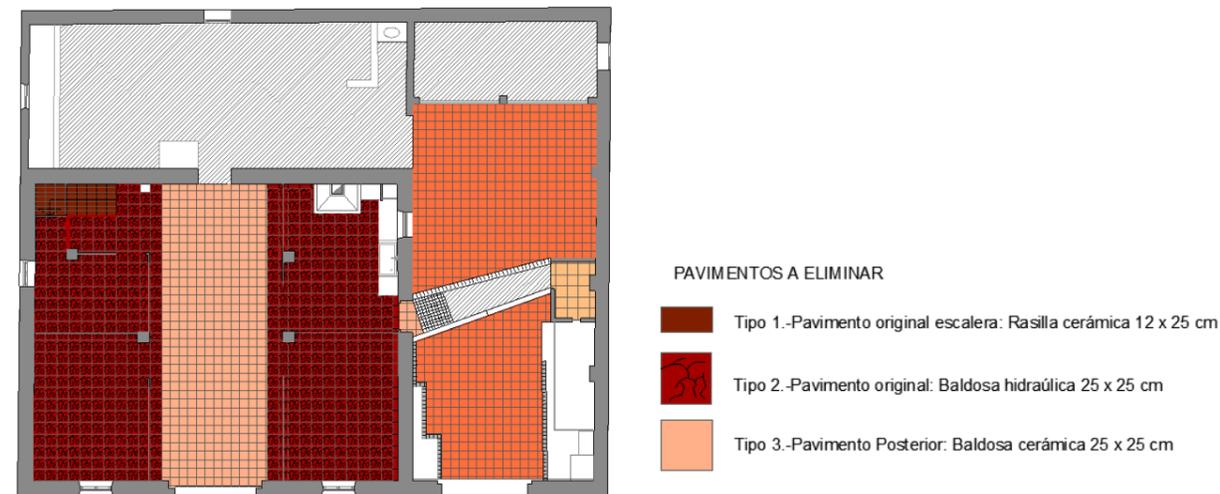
Pavimentos alquería Visquet. Fuente: autor propio
